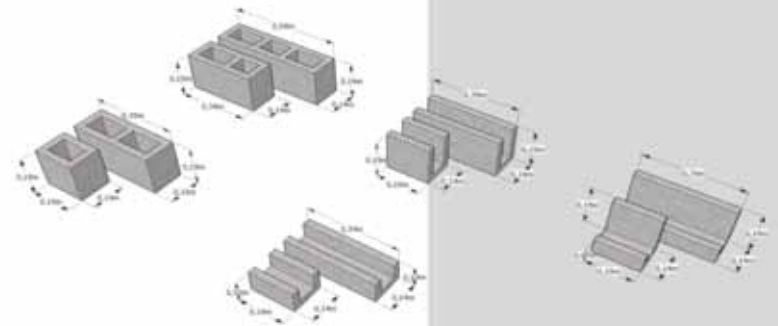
Detalhes alvenaria estrutural. Fonte: RAMALHO, M.A. & CORREA, M.R.S. *Projeto de Edifícios de Alvenaria Estrutural*. Editora PINI. São Paulo, 2003
